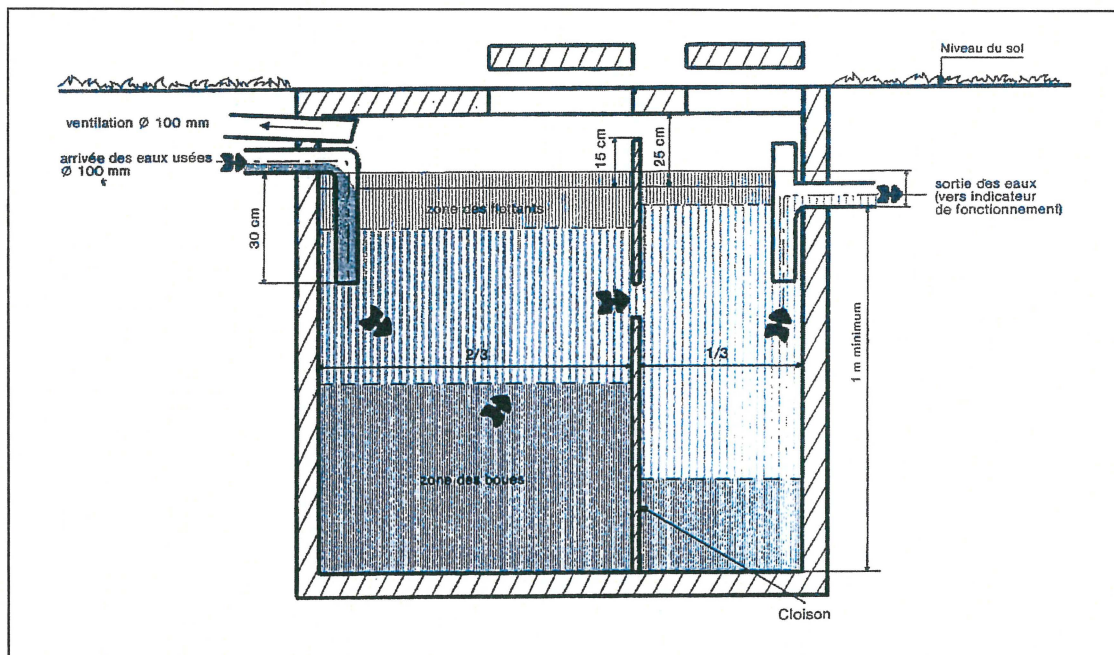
coupe de détail d'une fosse septique toutes eaux
